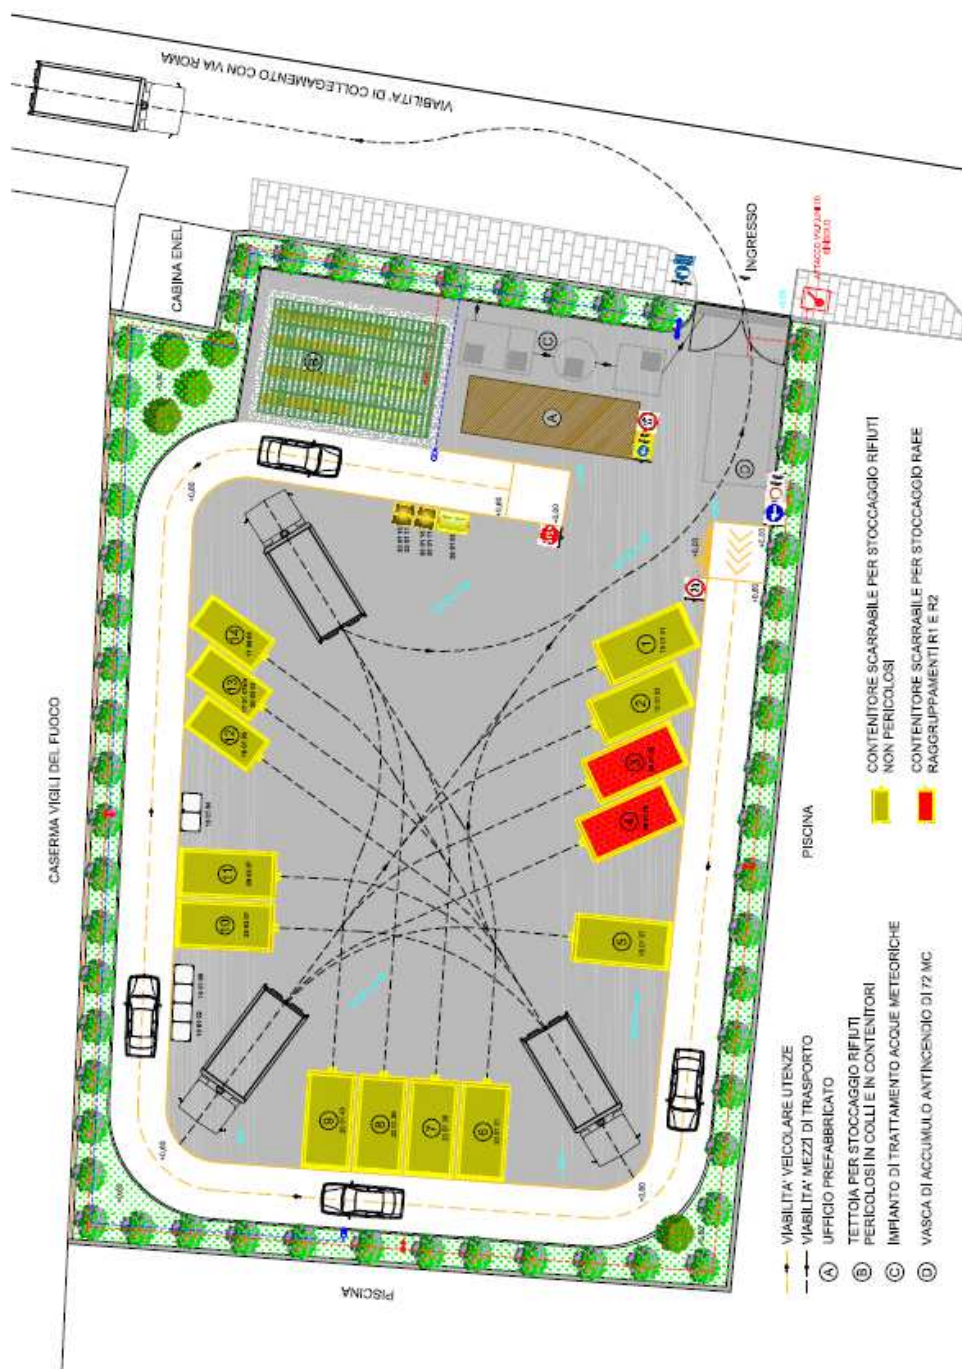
Planimetria tipo di Centro Comunale di Raccolta
